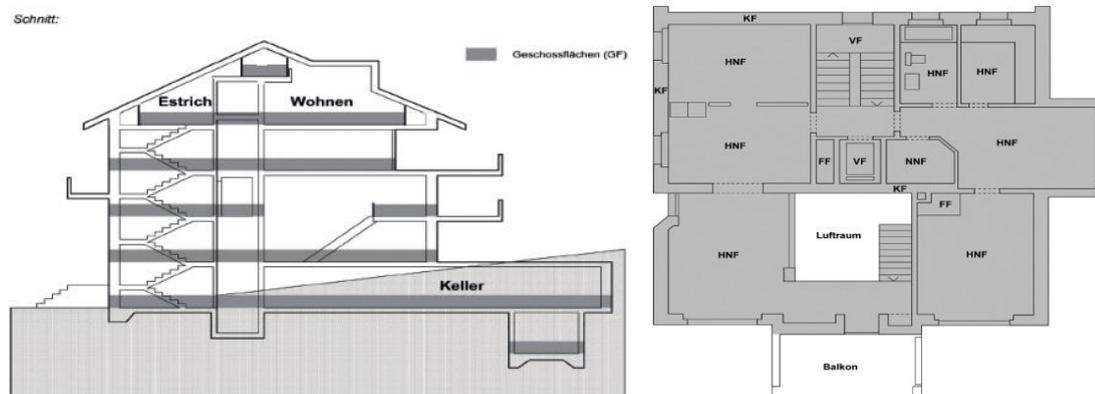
Figur 8.2 Geschossflächenziffer, IVHB
